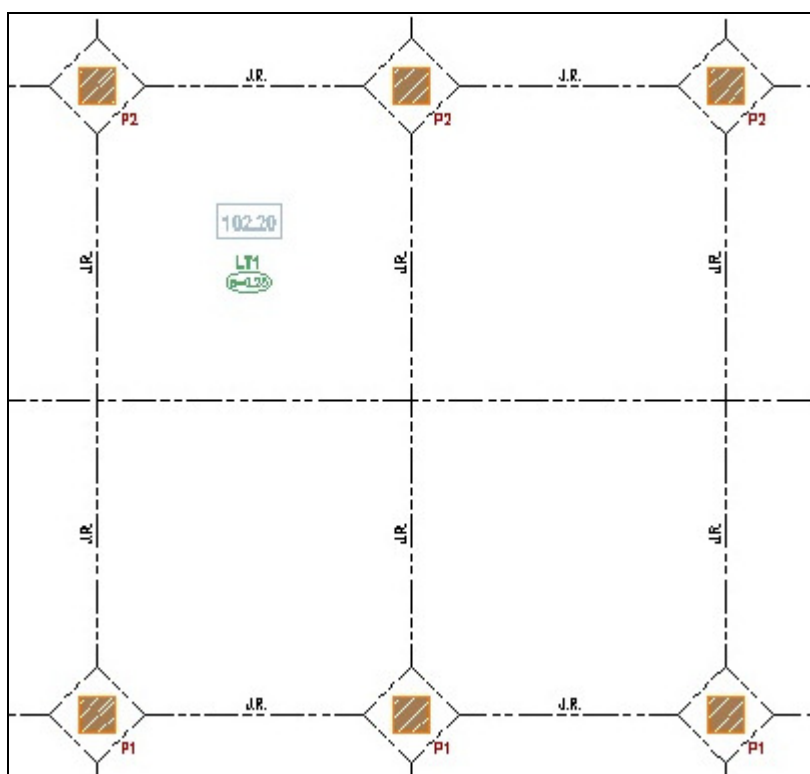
Planta do pavimento térreo: pormenor de juntas de retracção no pavimento e em forma de diamante, à volta dos pilares.
